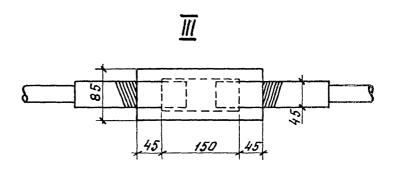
Усиление железобетонных балок стальным шпренгелем
